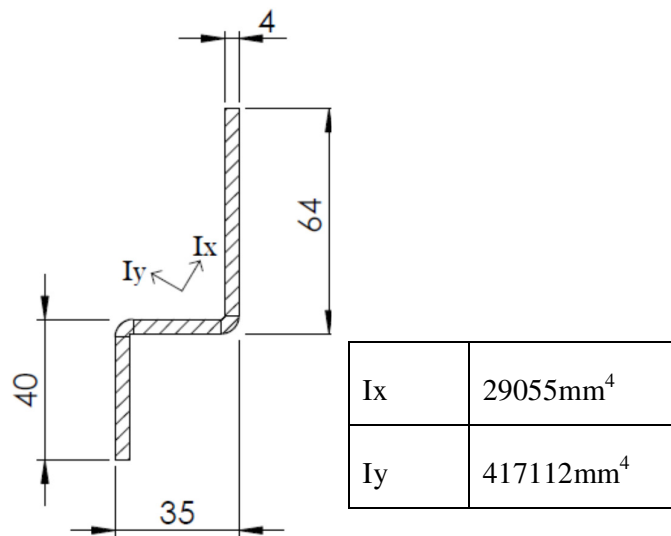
Parte da secção transversal do pilar considerado para o cálculo à encurvadura.
